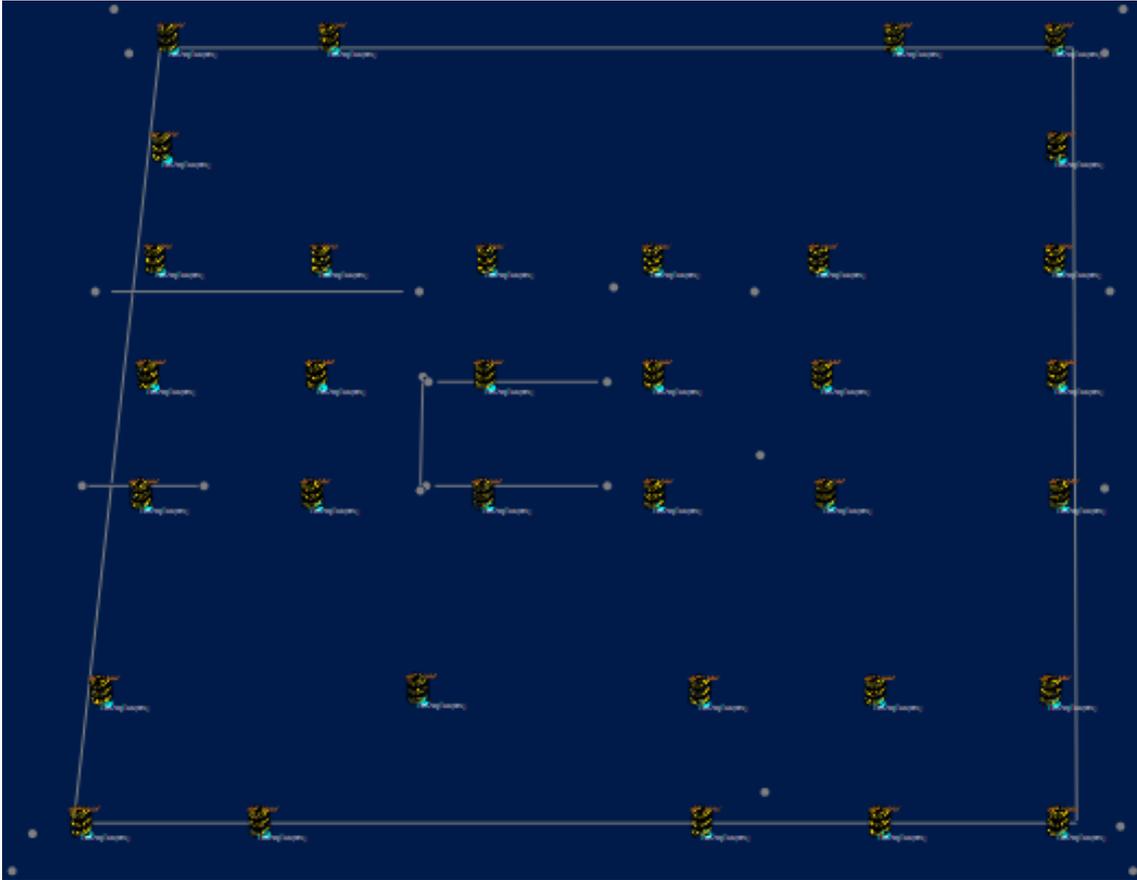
Modelo en RAM de la platea con disposición de pilotes
